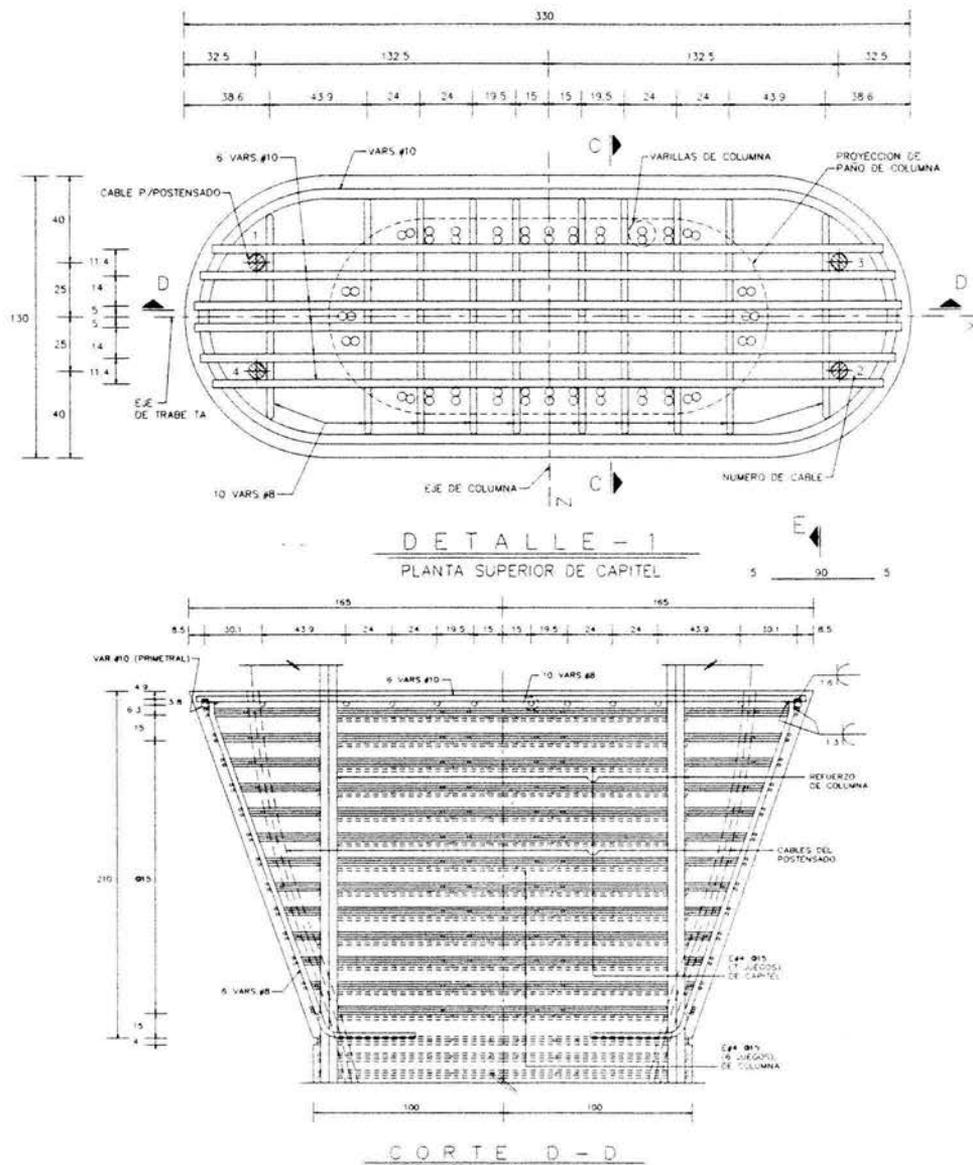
Refuerzo ordinario y Postensado de columnas
